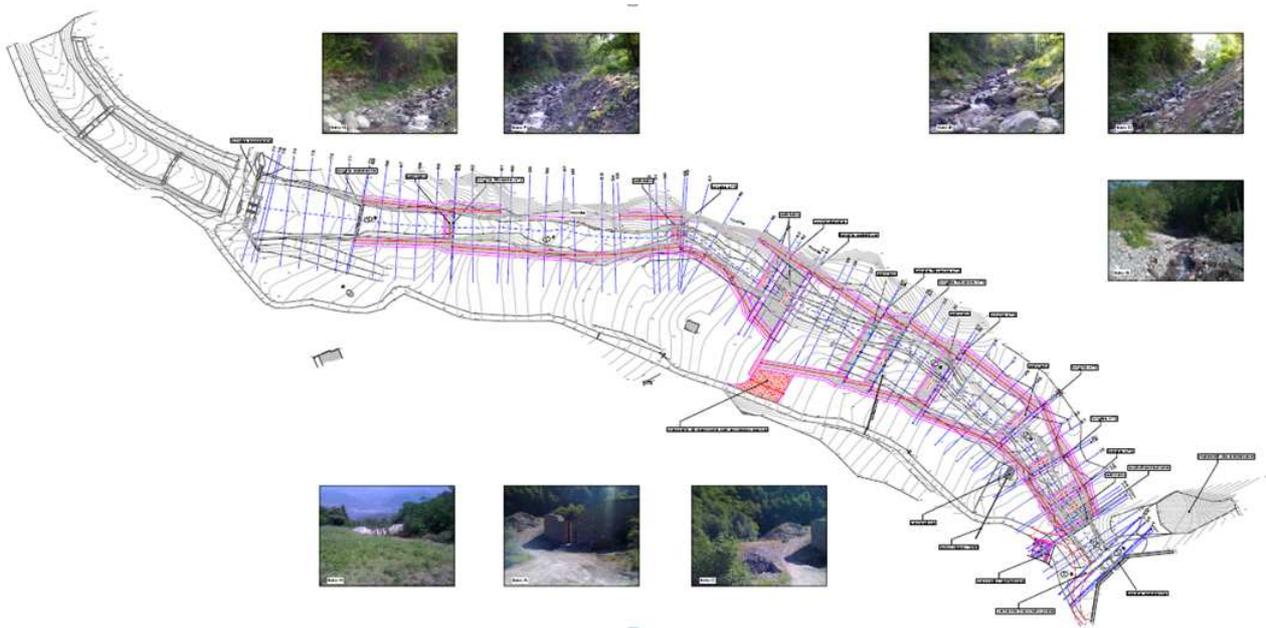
Planimetria di rilievo, inserimento delle opere e viste fotografiche.
